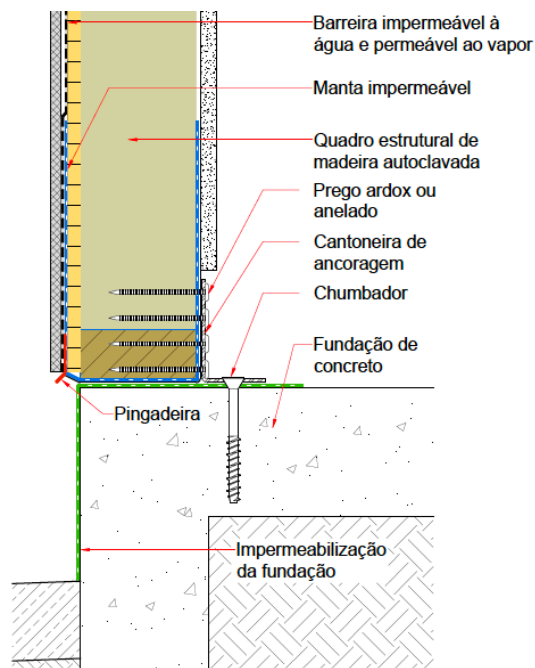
Detalhe da fixação da parede externa no elemento de fundação.
